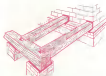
Общий вид готовой обшивки вершиной с пазом для столбов.
